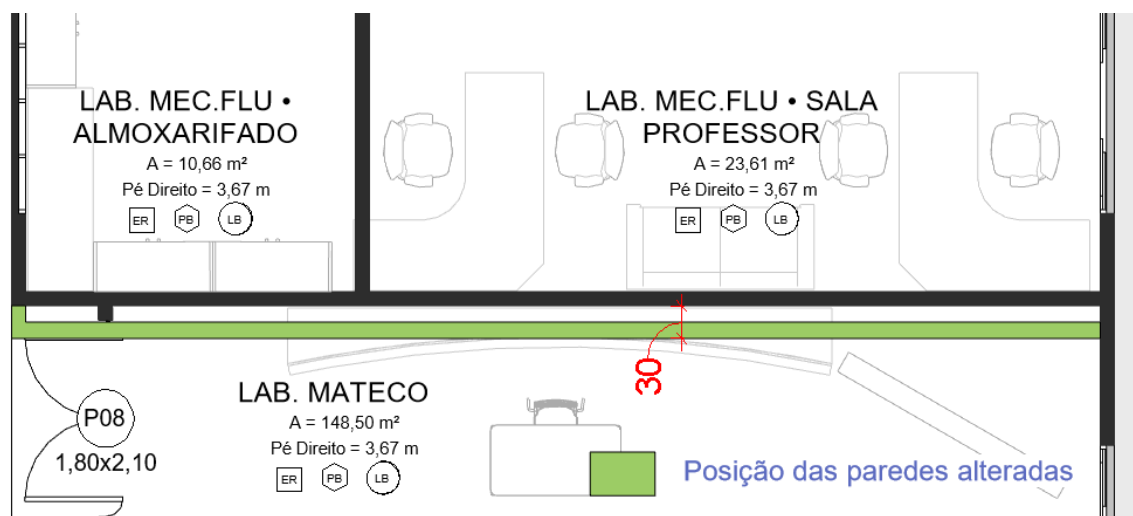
Alteração da posição da parede de divisa do almoxarifado e sala do professor do Laboratório de Materiais de Construção Civil – pavimento térreo
